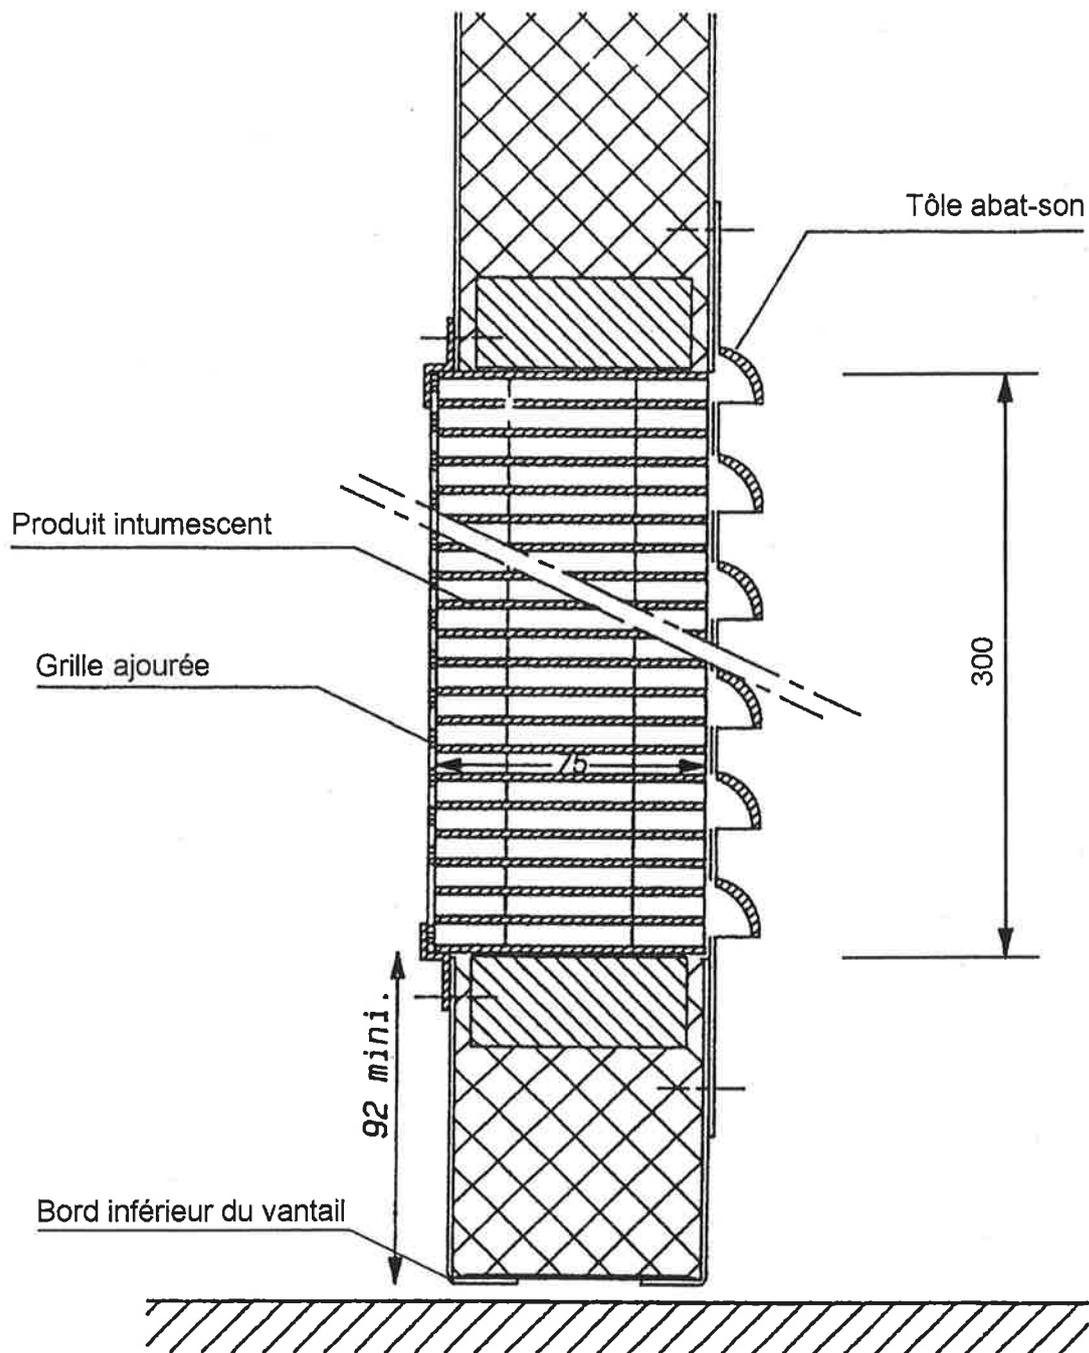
Coupe verticale de la grille de ventilation en bas du vantail
